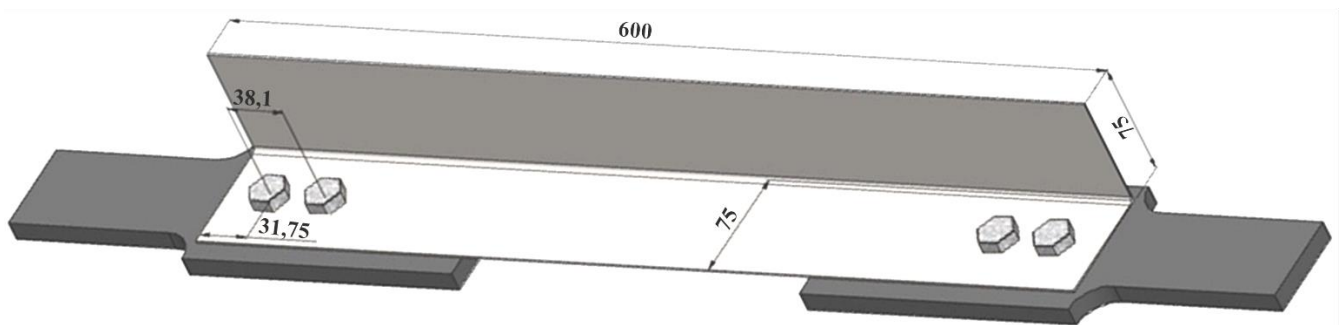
Dimensões (mm) da ligação na cantoneira A2-B-221
